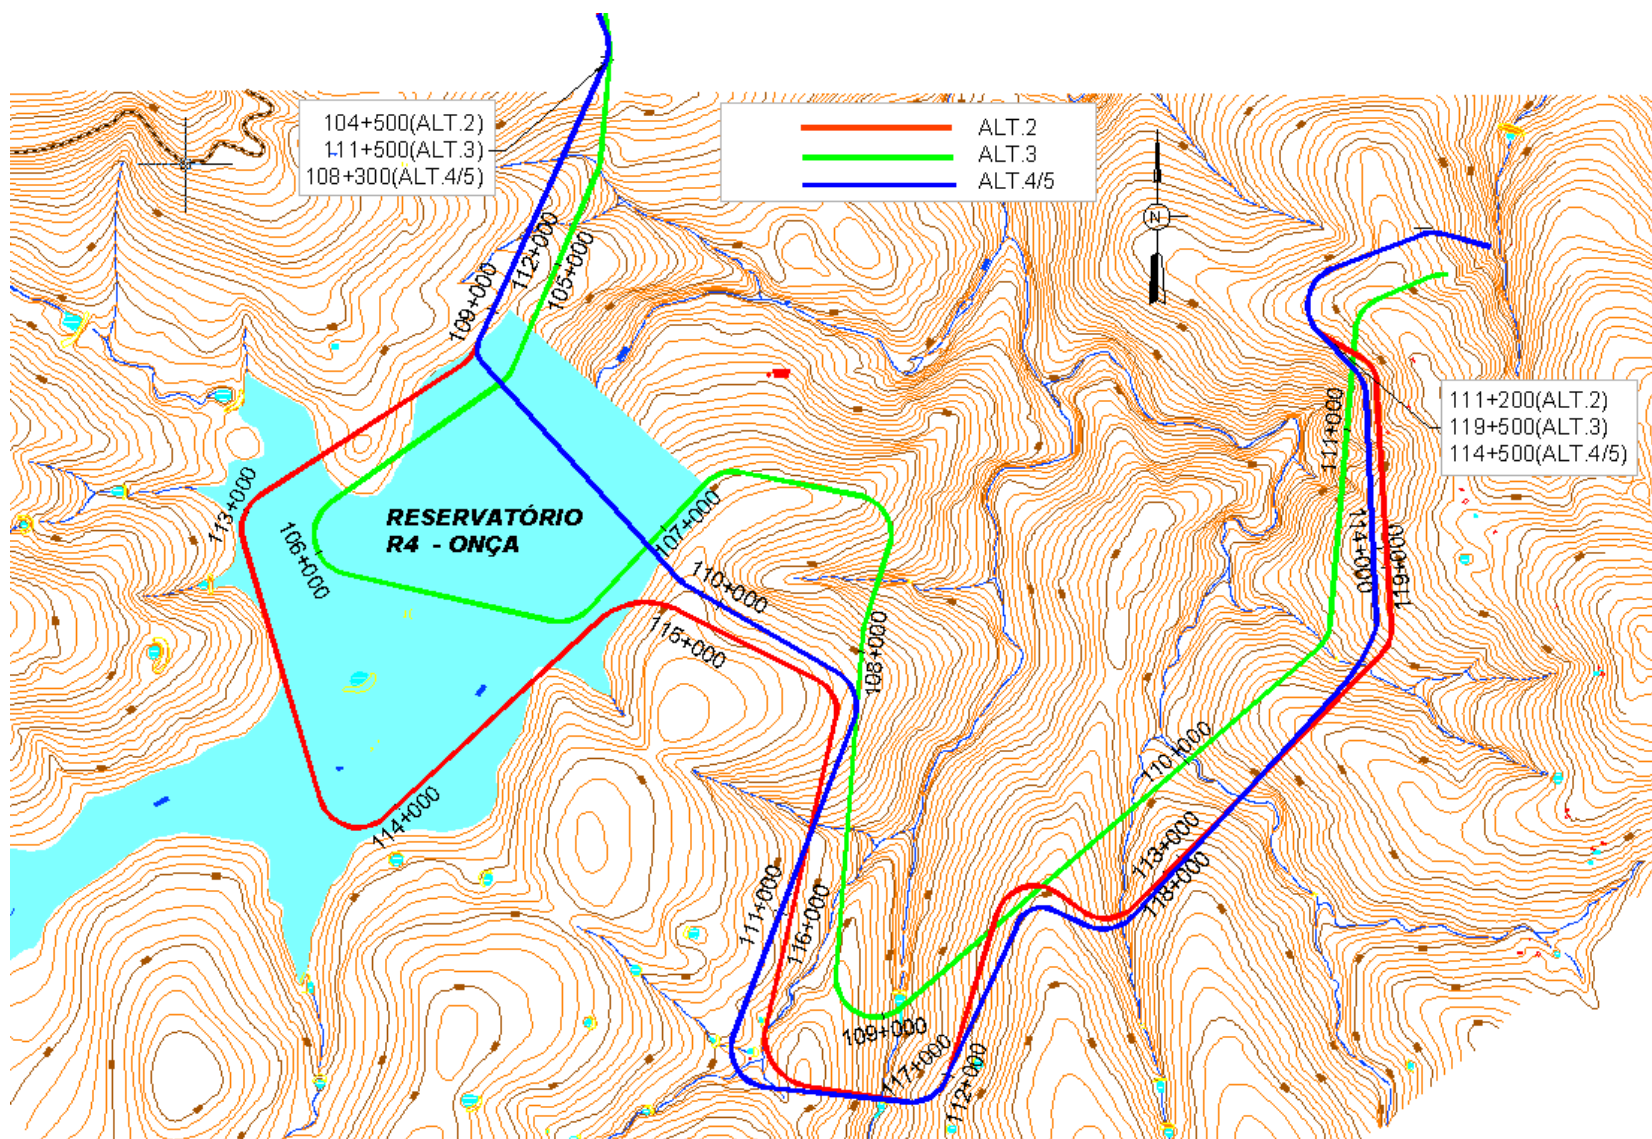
Estudo de Traçados em Planta – Subtrecho junto ao Reservatório R4 (Onça)
